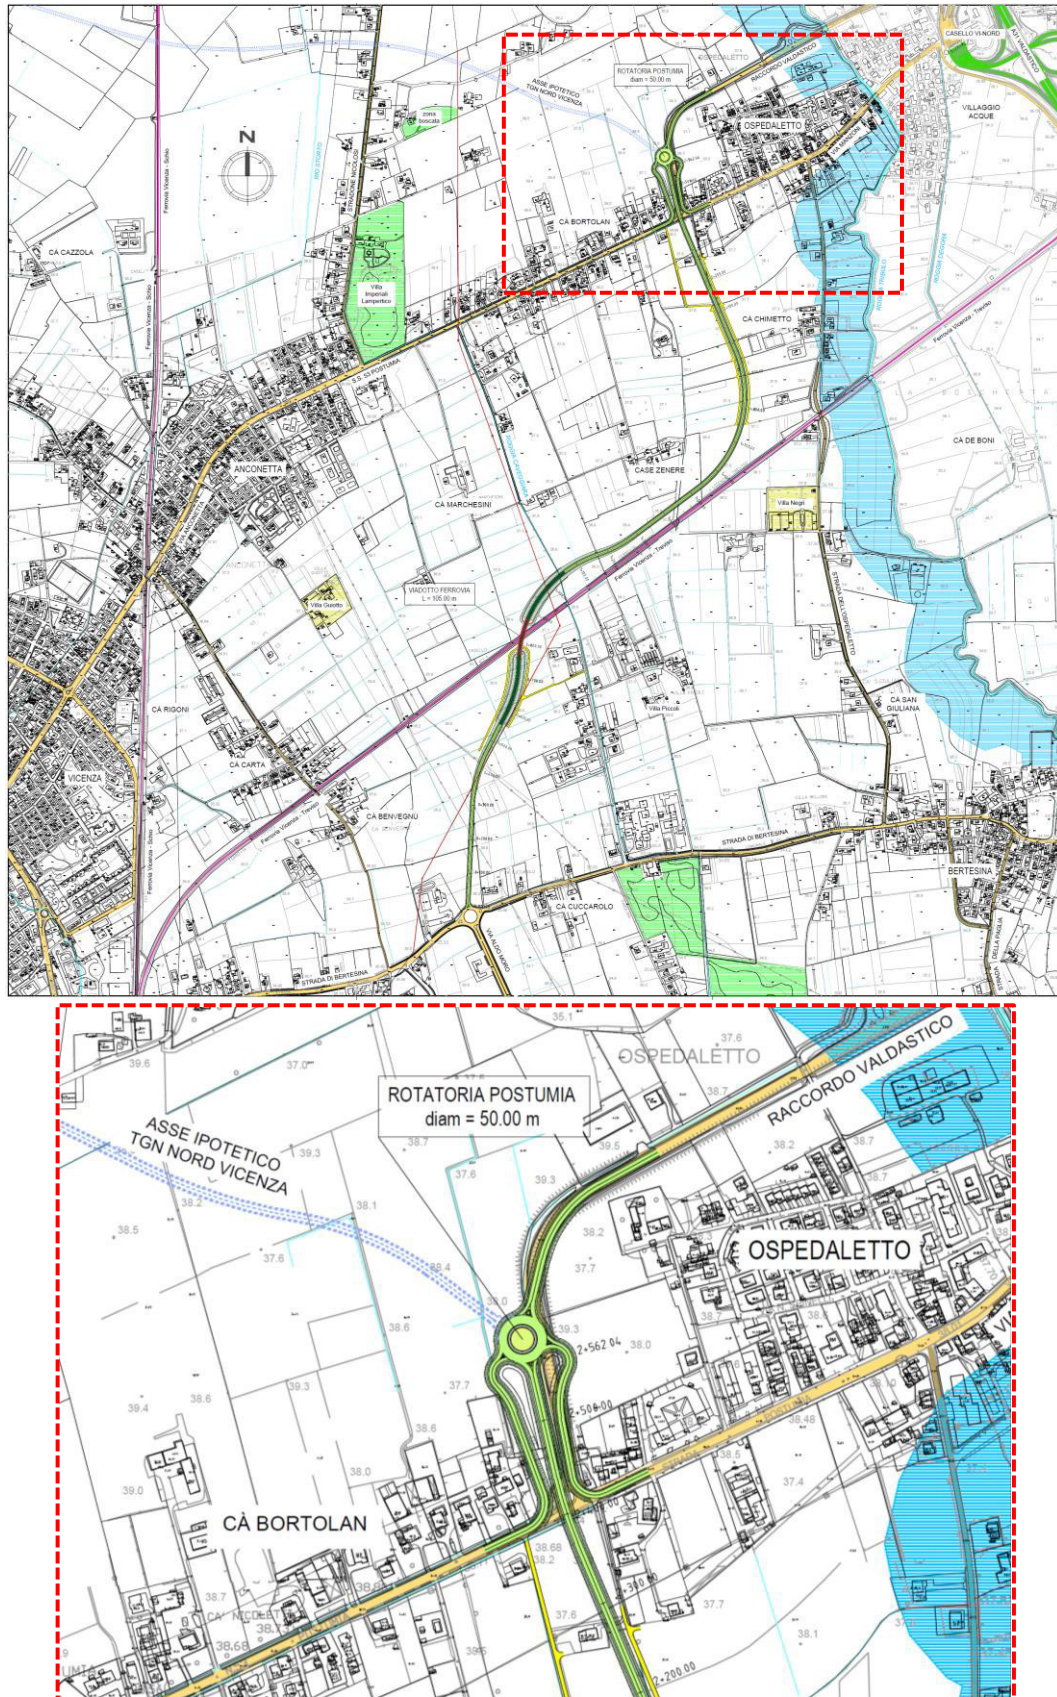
estratto della planimetria di Alternativa Ospedaletto B e zoom attraversamento SS53
